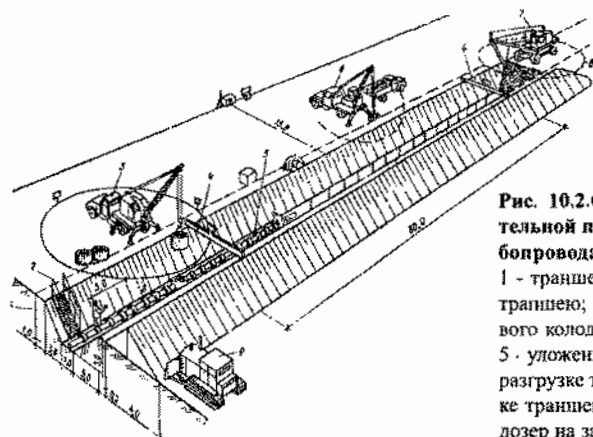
Схема организации строительной площадки при монтаже трубопровода из керамических труб: 1 - траншея; 2 - лестница для спуска в траншею; 3 - кран на монтаже смотрового колодца; 4 - переносные обноски; 5 - уложенный трубопровод; 6 - кран на разгрузке труб; 7 - экскаватор на отрывке траншеи; 8 - опасная зона; 9 - бульдозер на засыпке траншеи
